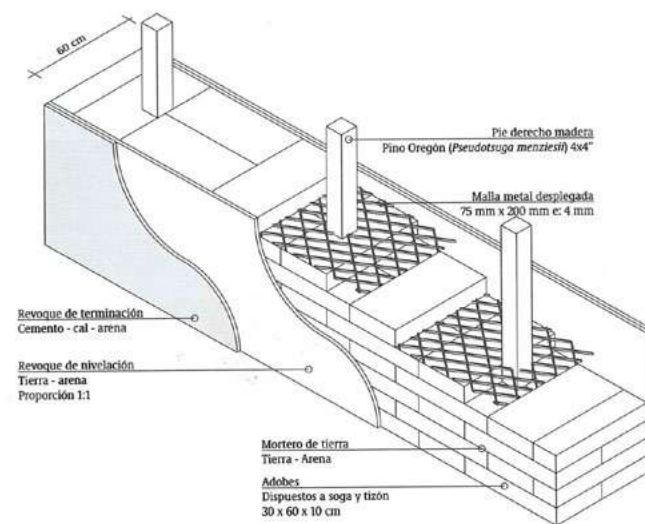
Sistema constructivo utilizado en el Instituto Chileno Norteamericano, María Elena, Región de Antofagasta, Chile. © Natalia Jorquera y David Cortez, 2022
